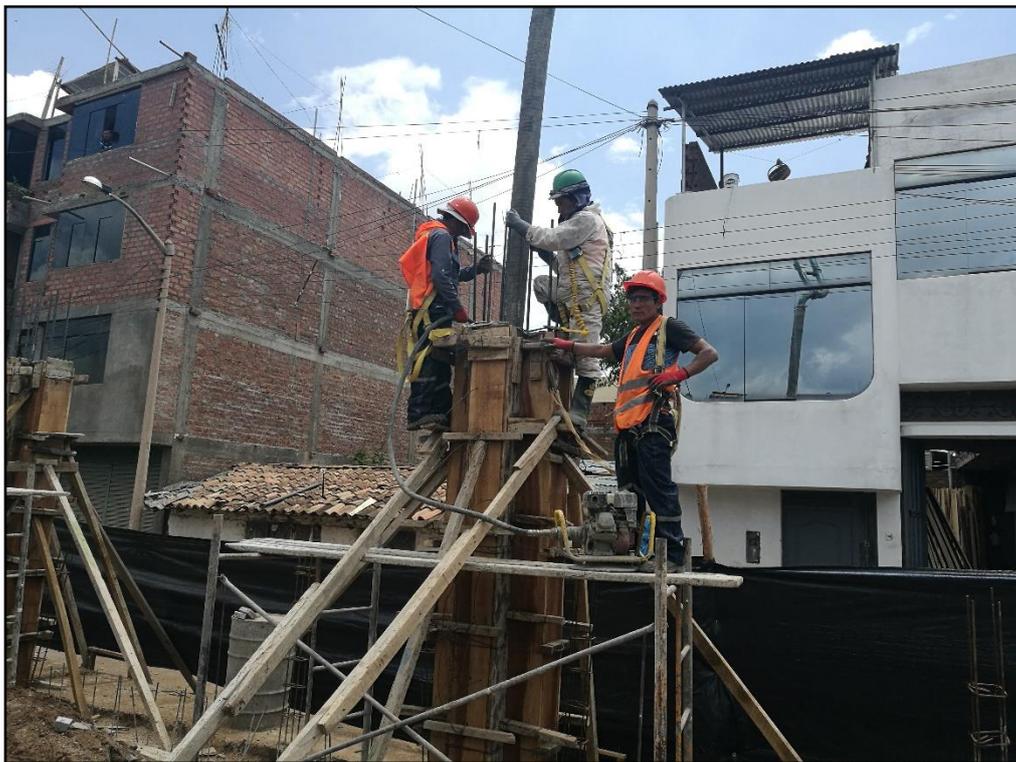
VACIADO DE COLUMNAS DE MODULO 01 Y 02 CONCRETO
